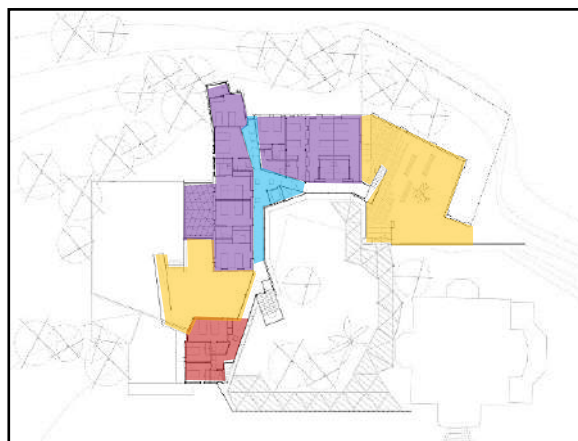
Comunidad Terapéutica en Arenys – Plano de Distribución segunda planta
